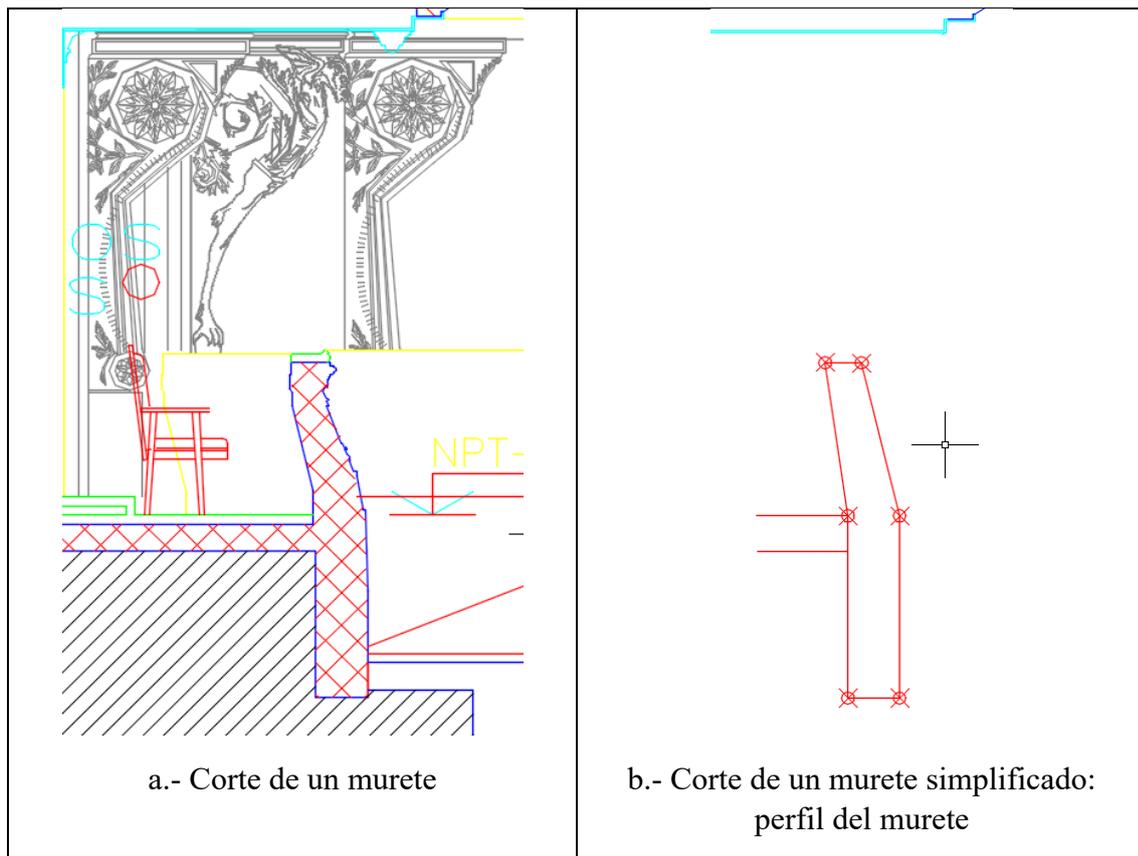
Replanteo del perfil del murete. (Elaboración propia)
